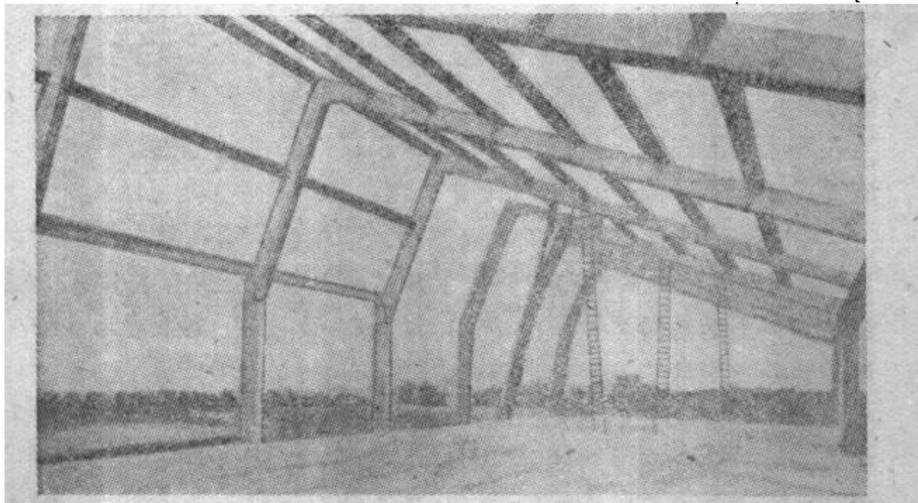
锯齿形屋盖的装配式钢筋混凝土构件
